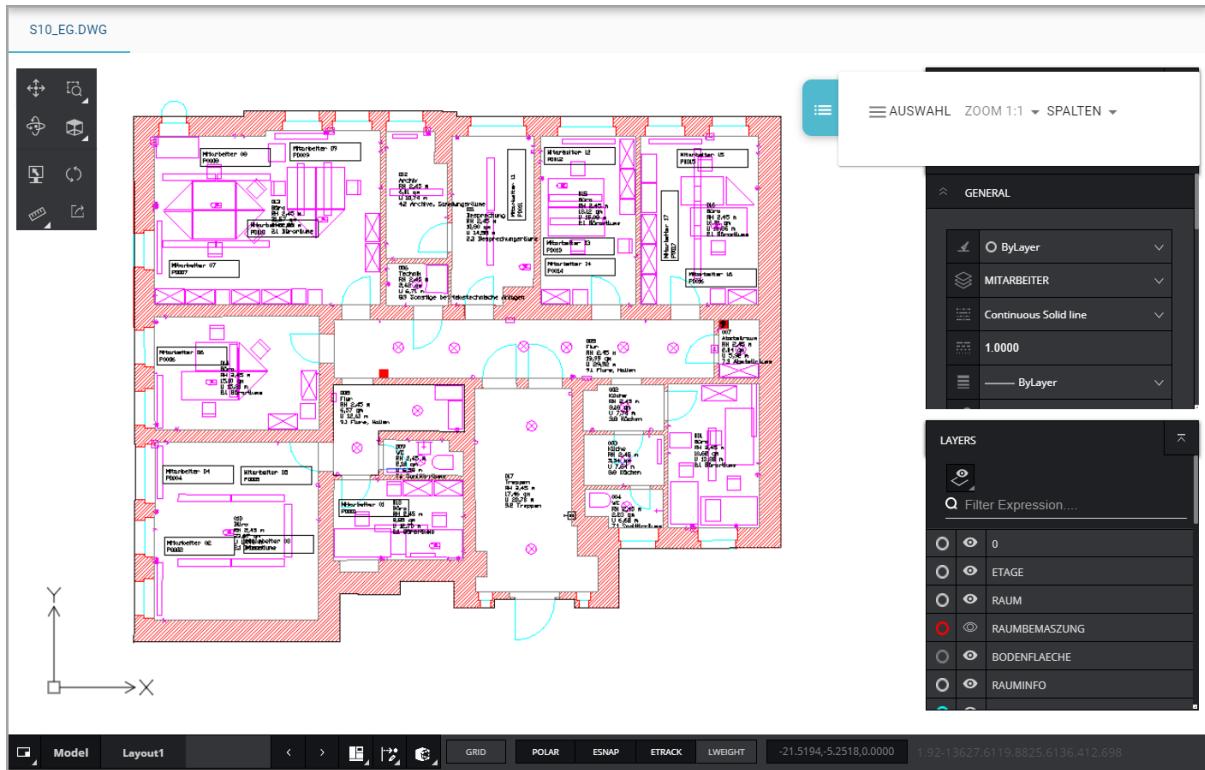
Anzeige eines Geschoss-Grundrisses.
